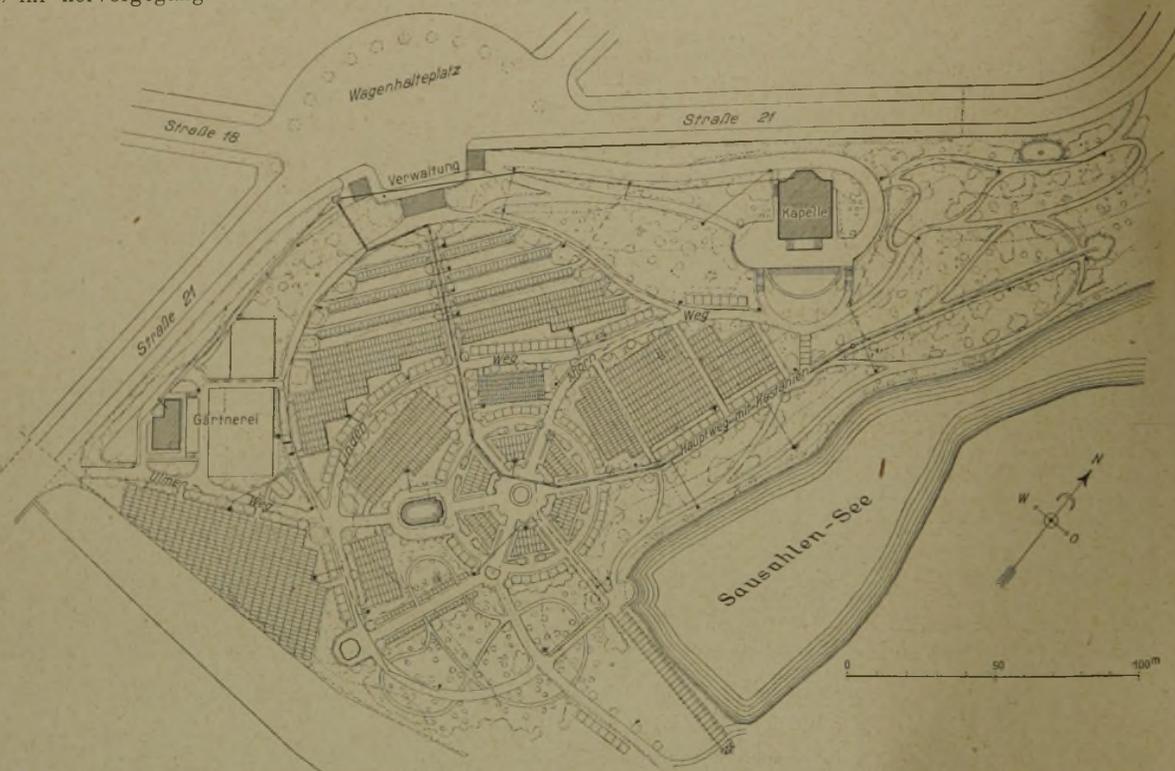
Lageplan des westlichen Teiles des Friedhofes (mit Bepflanzung und Wasserleitung).
